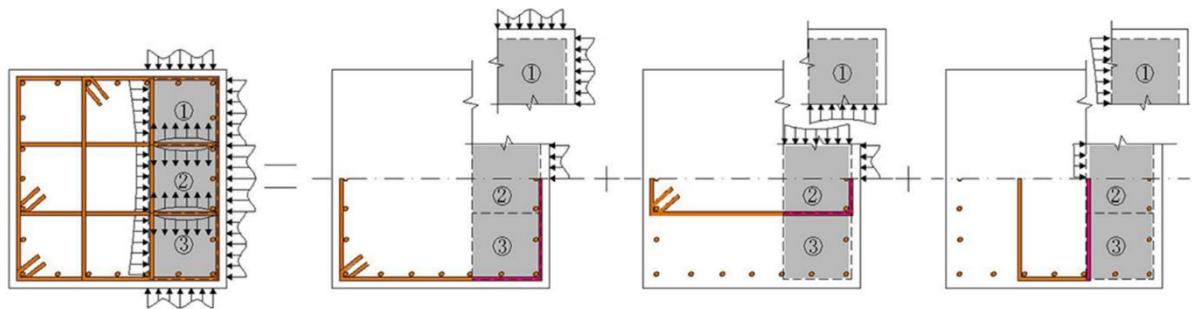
Tensão confinante da armadura transversal no concreto (ZHANG et al., 2020).
